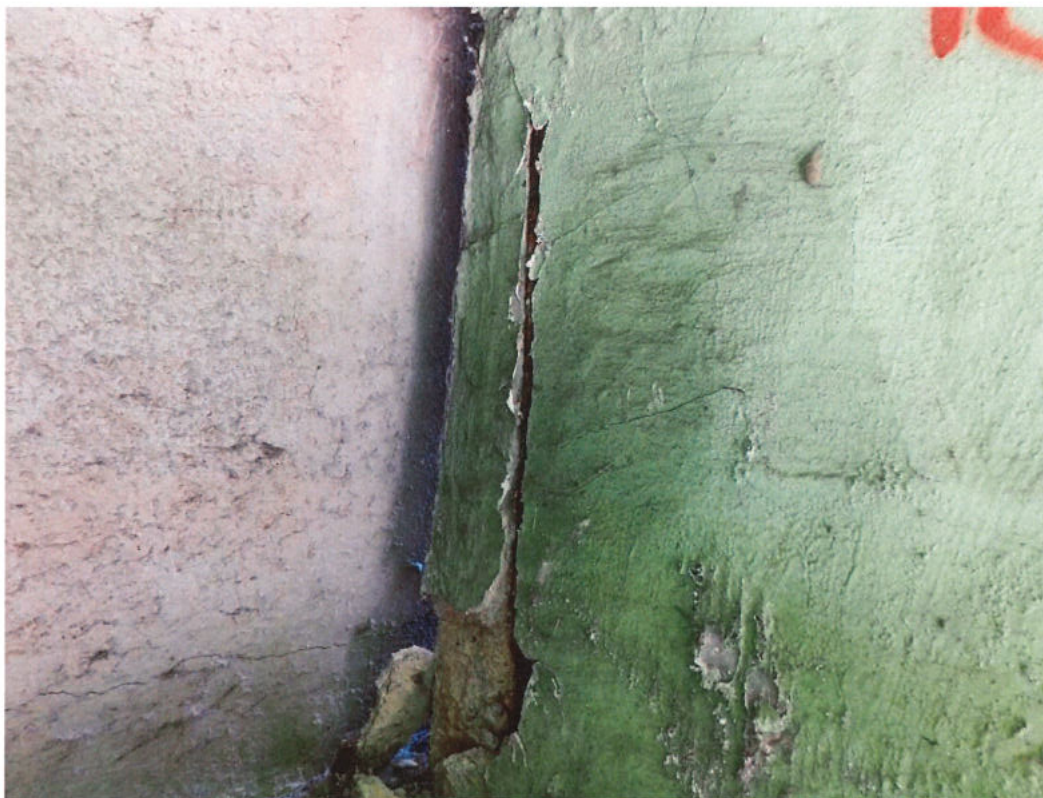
Konstrukcja dźwigarów głównych – lokalny ubytek betonu na końcu dźwigara nad przyczółkiem od strony m. Jaślany.
